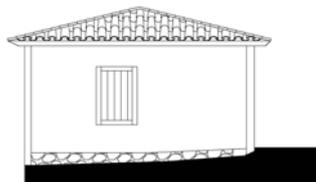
Fachada Esquerda B (Acervo PROAU/FAU/UnB).
